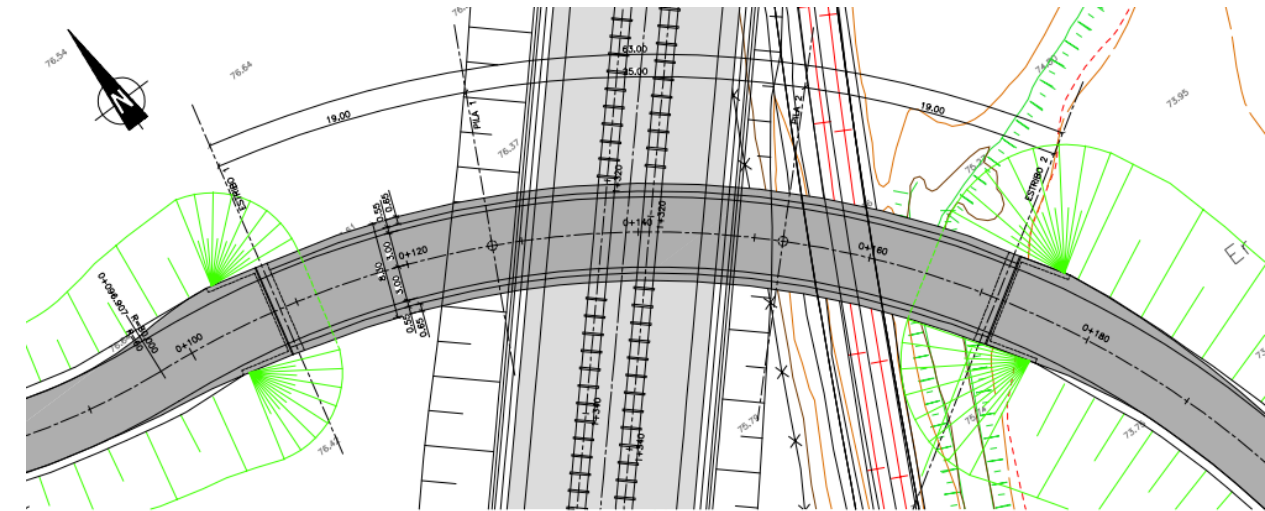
PLANTA PS CAMINO SOBRE FF.CC. P.K. 1+330
